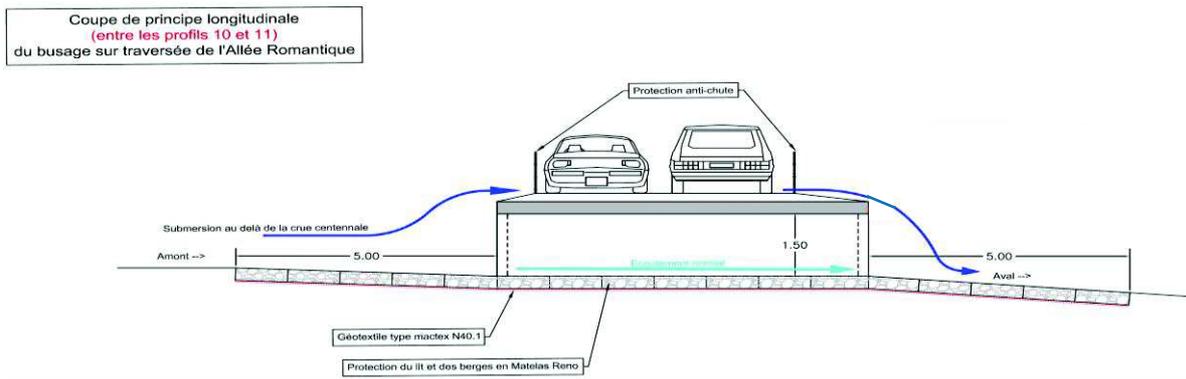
Coupes de principe longitudinale de l'ouvrage de traversée de l'Allée Romantique
